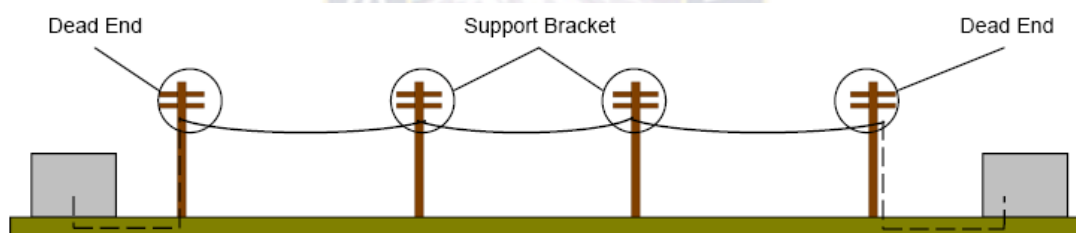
Instalación de una red de planta externa con herrajes adecuados
